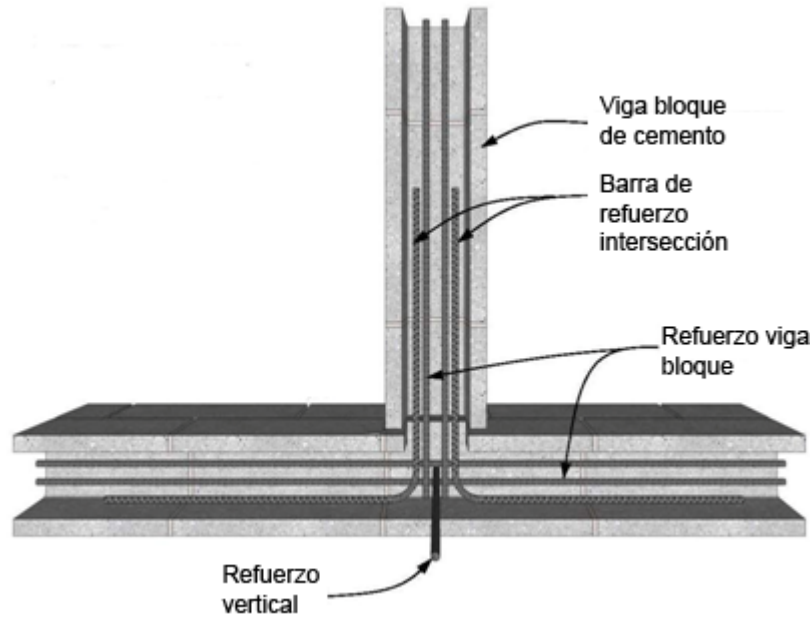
Anclaje de los extremos de las barras de refuerzo horizontal en T (IMI, 2009)
